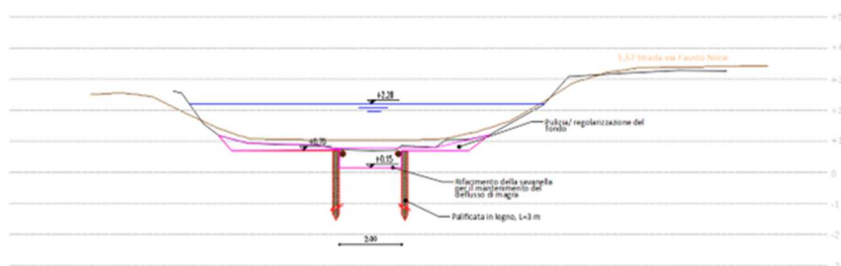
Sezione tipo del diversivo San Nicola – Zozò con rifacimento della savanella delimitata con palificate di legno
